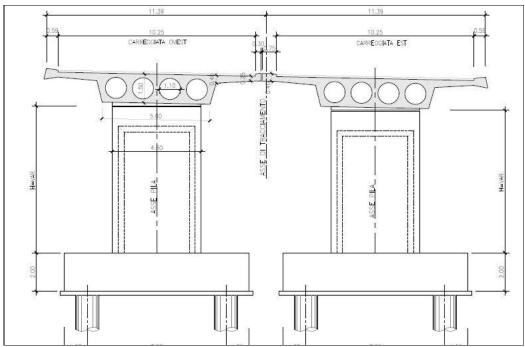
sezione tipica esistente del viadotto Vetoio e SS17
